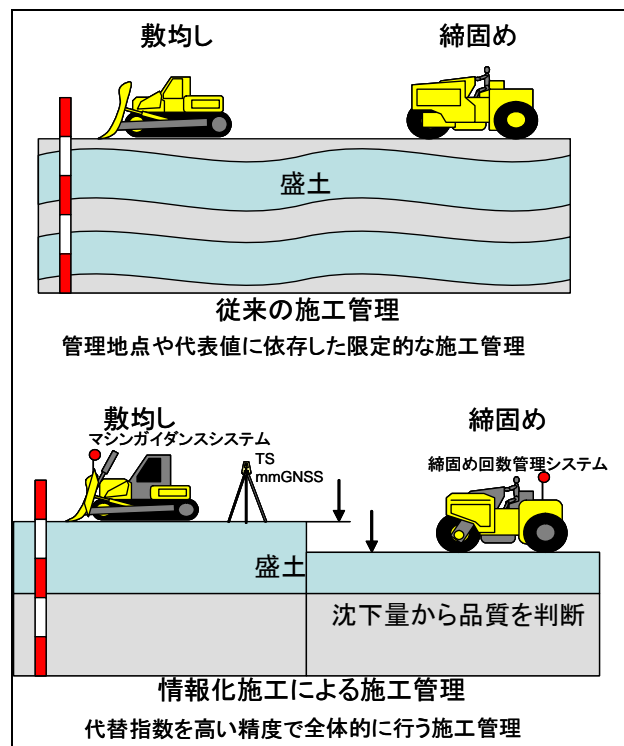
情報化施工に適した施工管理指標による施工のイメージ
